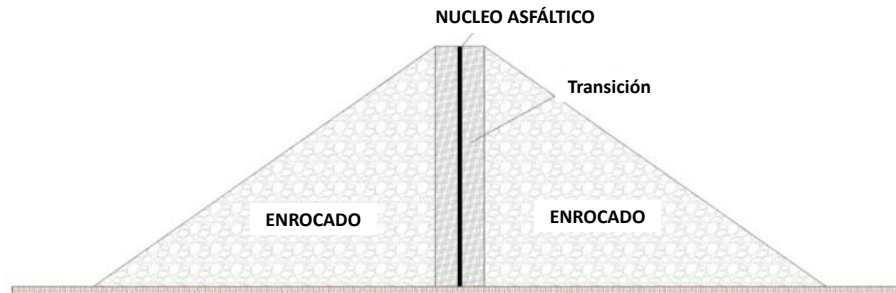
Sección transversal de una presa con núcleo de concreto asfáltico vertical.
